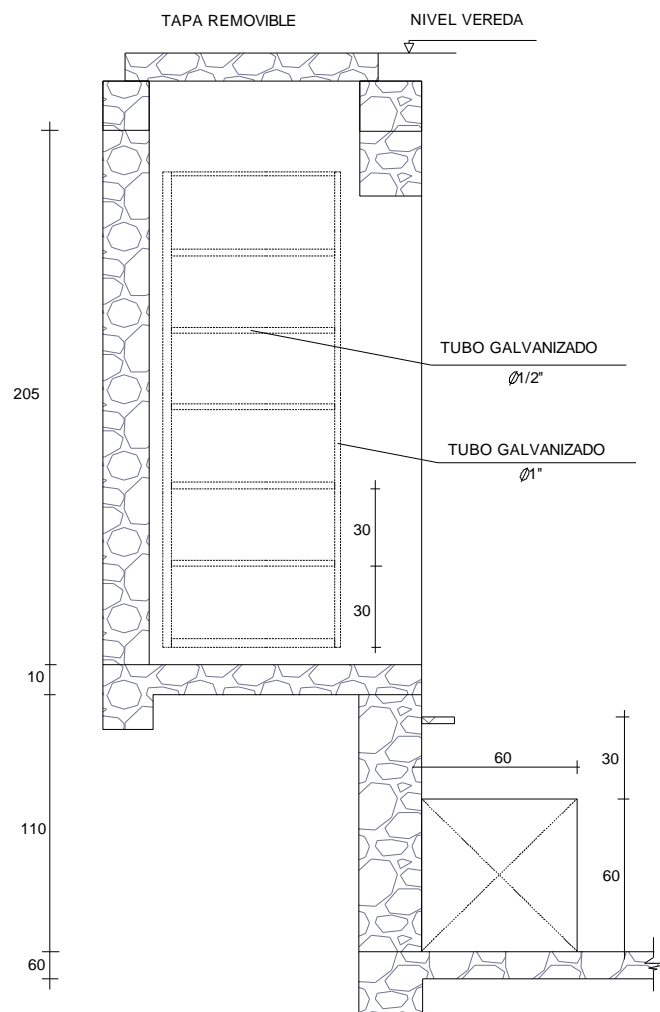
Escalerilla y ubicación para acceso a cámaras subterráneas
